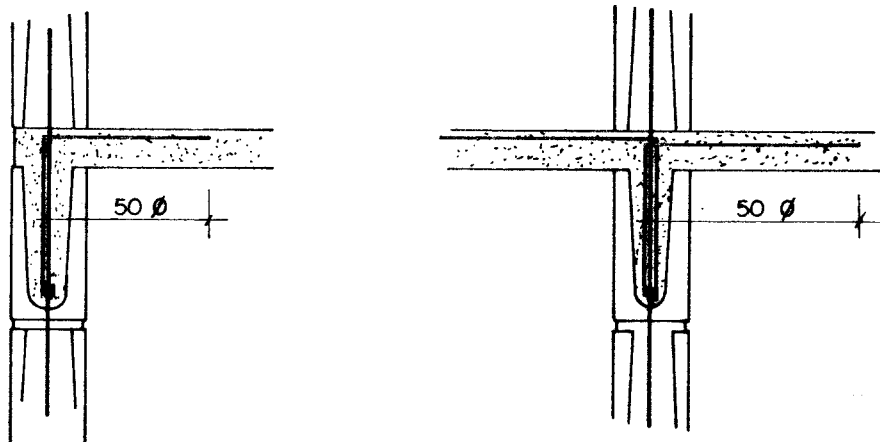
POSIÇÃO DAS ARMADURAS NAS LIGAÇÕES EFETIVAS LAJE / PAREDE
